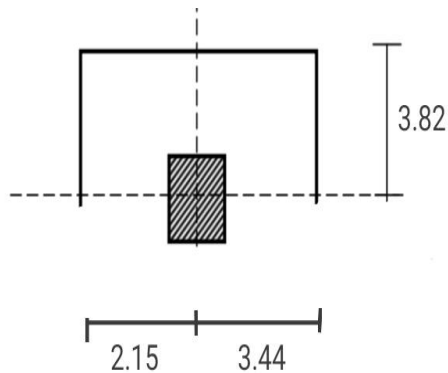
Surface revenant au poteau de rive (poteau N16)
